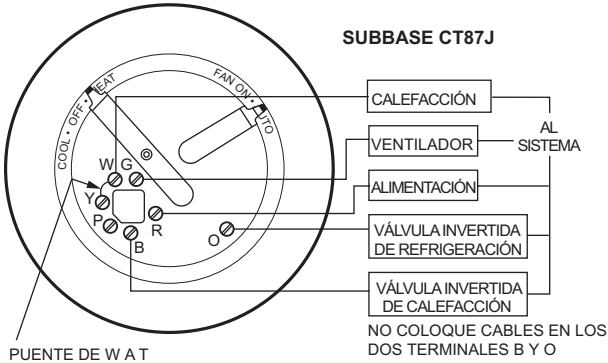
CT87B para un sistema de 5 cables calefacción/refrigeración.
